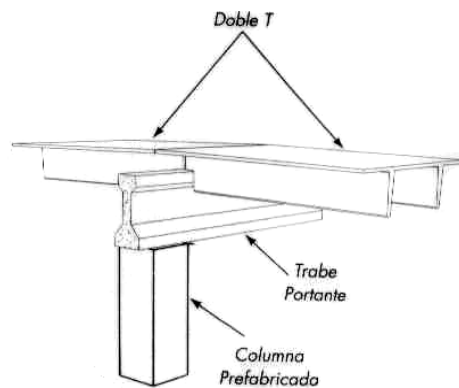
Apoyo de losas nervadas en traveses portantes (1)
